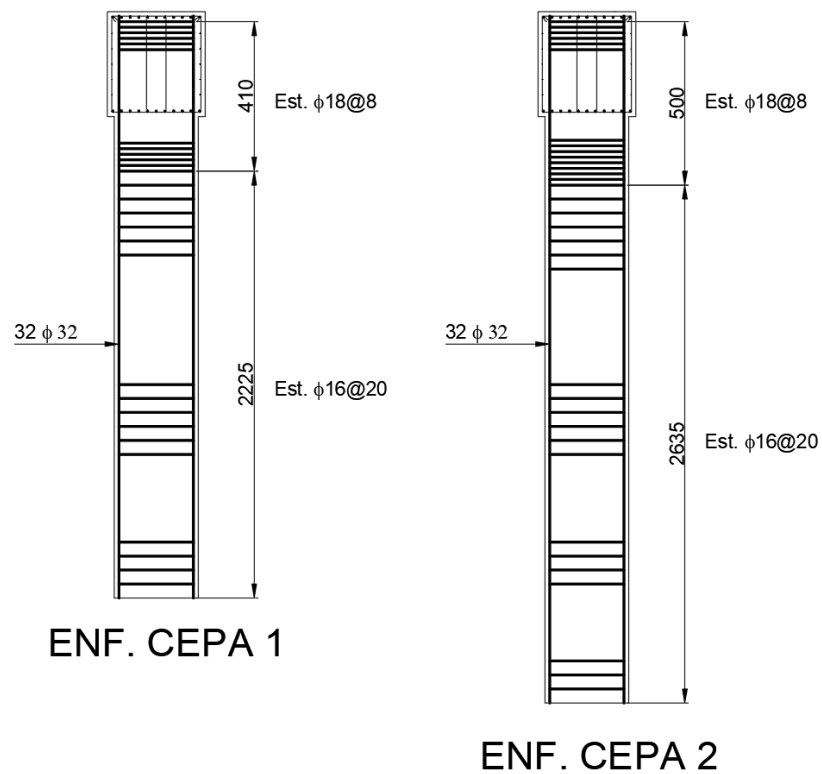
Armadura de diseño pilotes cepas (dimensiones en cm).
